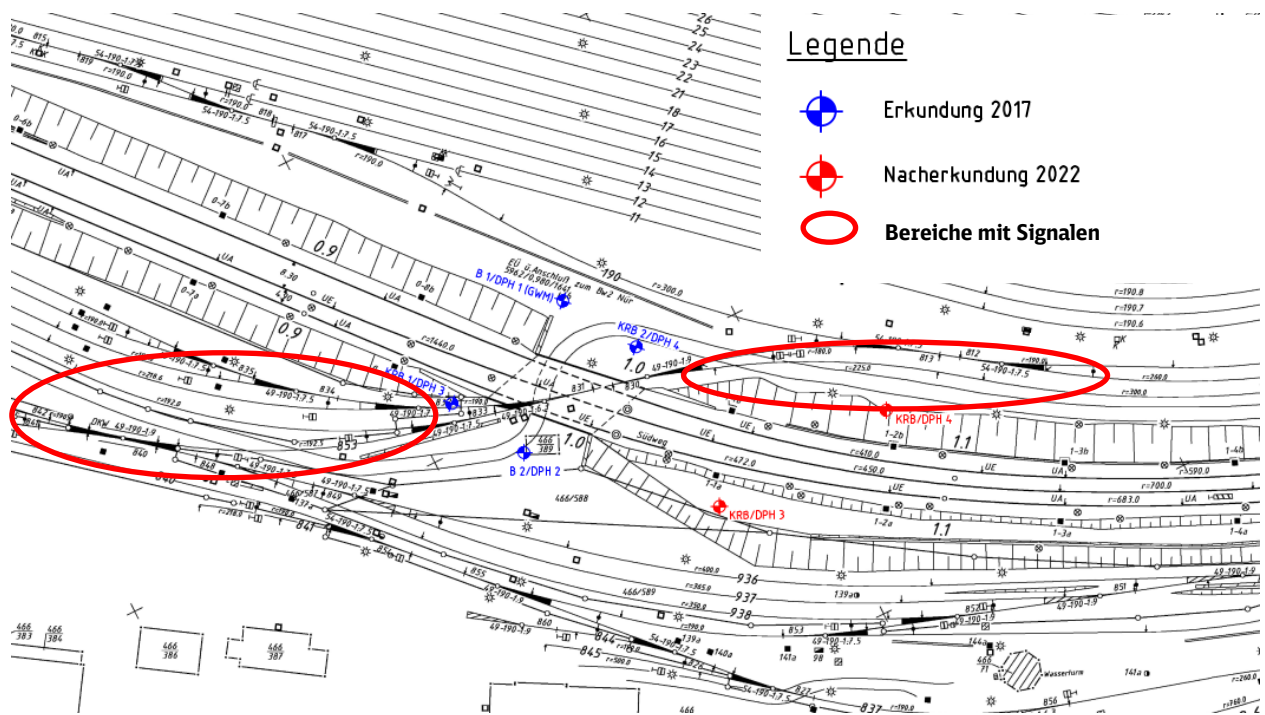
Ausschnitt Lageplan /U1/, modifiziert zur Übersicht.
